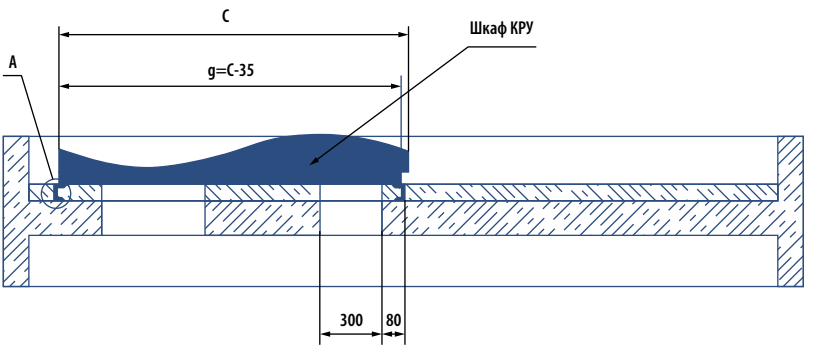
Пример конструкции фундаментной рамы (разрезы)
